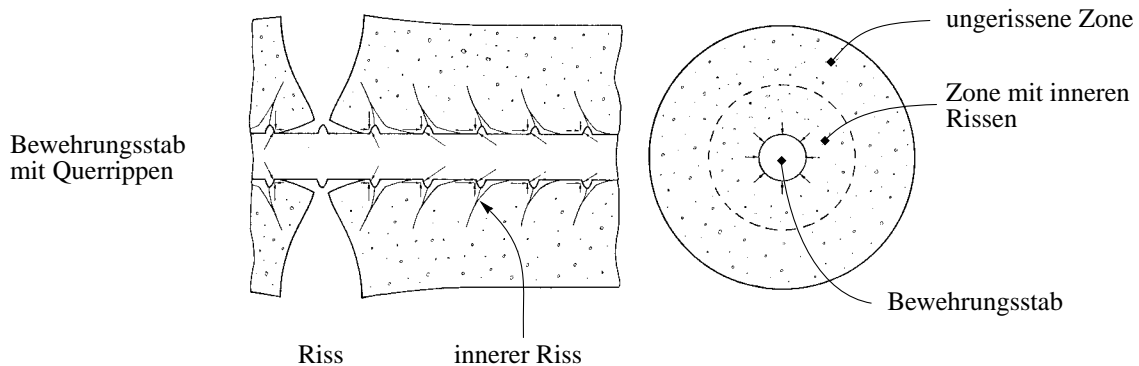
Schematische Darstellung der Verformungen des Betons im Bereich des Bewehrungsstabes nach der Bildung von inneren Rissen [aus Goto (1971)].
